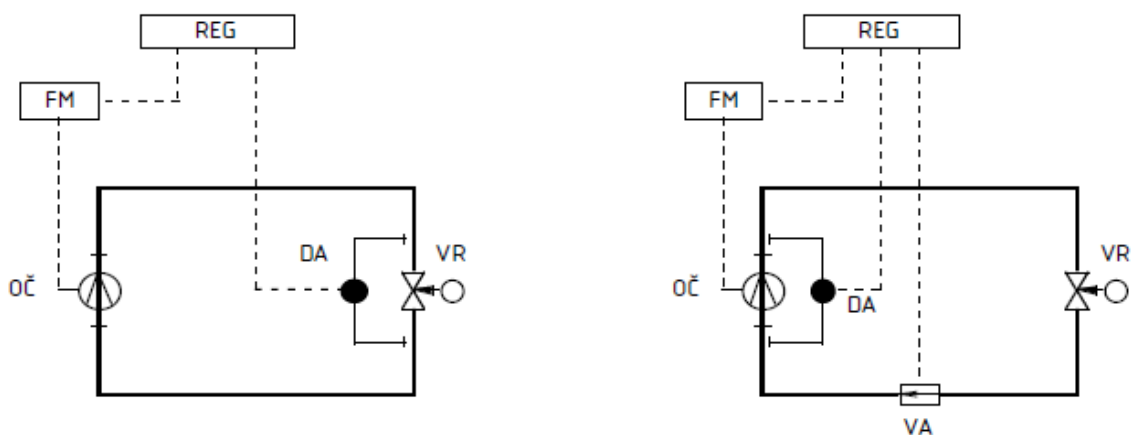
Princip regulace prostou změnou otáček [9]
